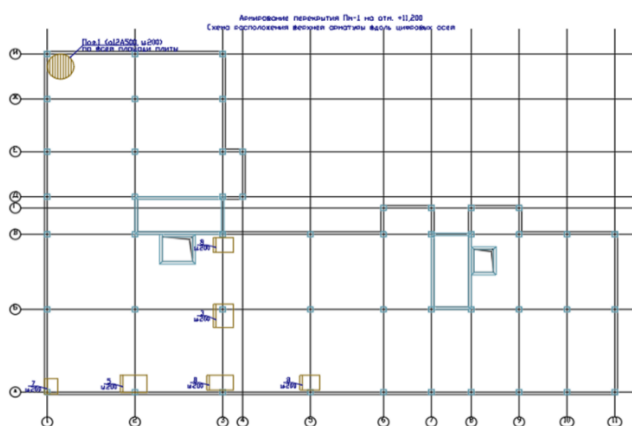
Верхнее армирование плиты по оси Y в ПК Лира-САПР
